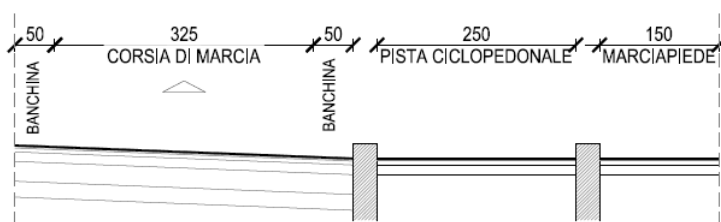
Sezione stradale di progetto – Via XXIV Maggio
